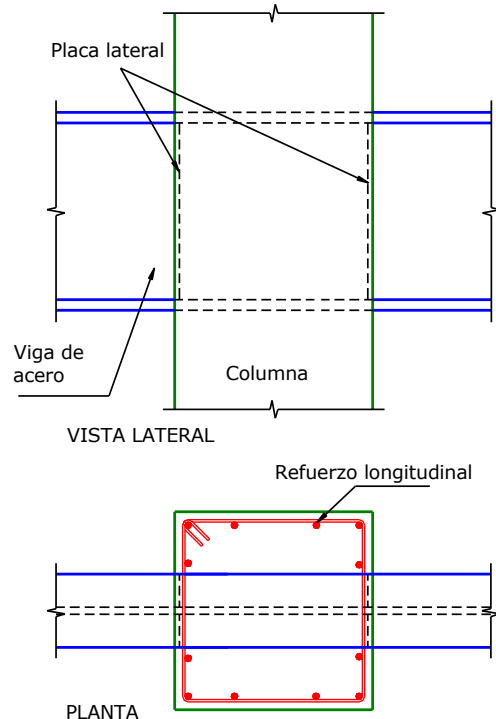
Conexión de una columna de hormigón armado con una viga de acero que atraviesa el nudo.
